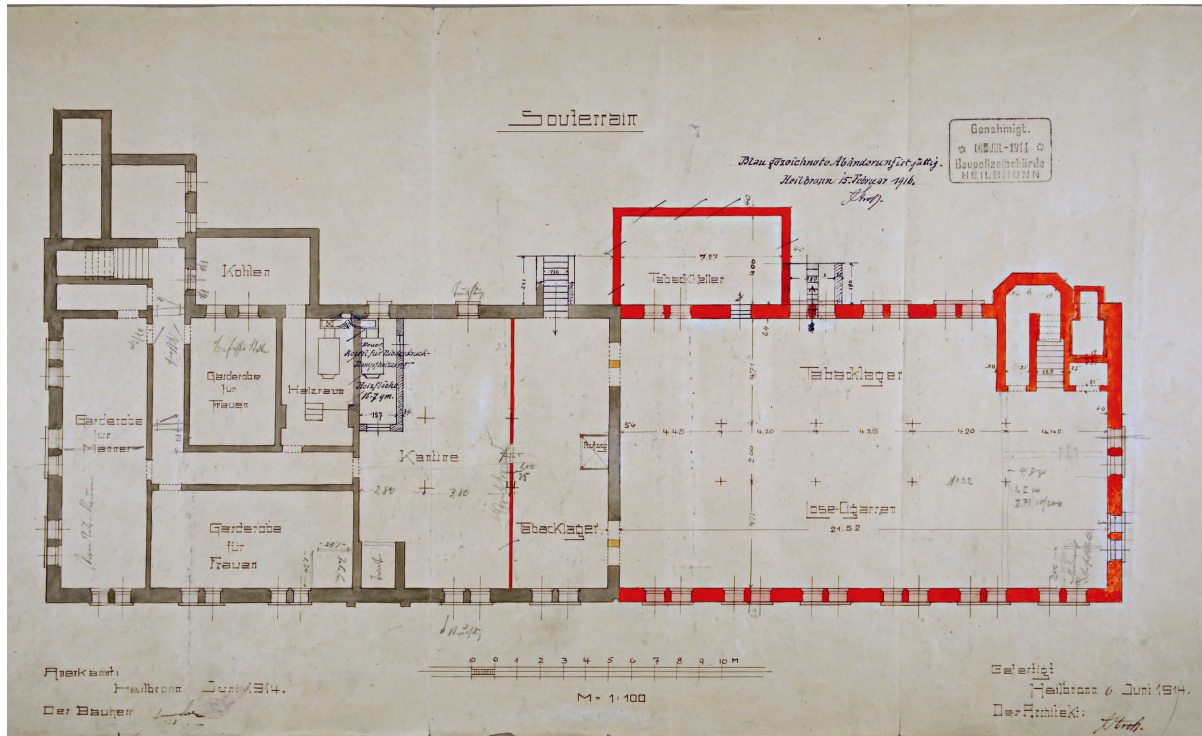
Fabrikerweiterung (rot) 1914: Grundriss. Foto: Stadtarchiv Heilbronn.
